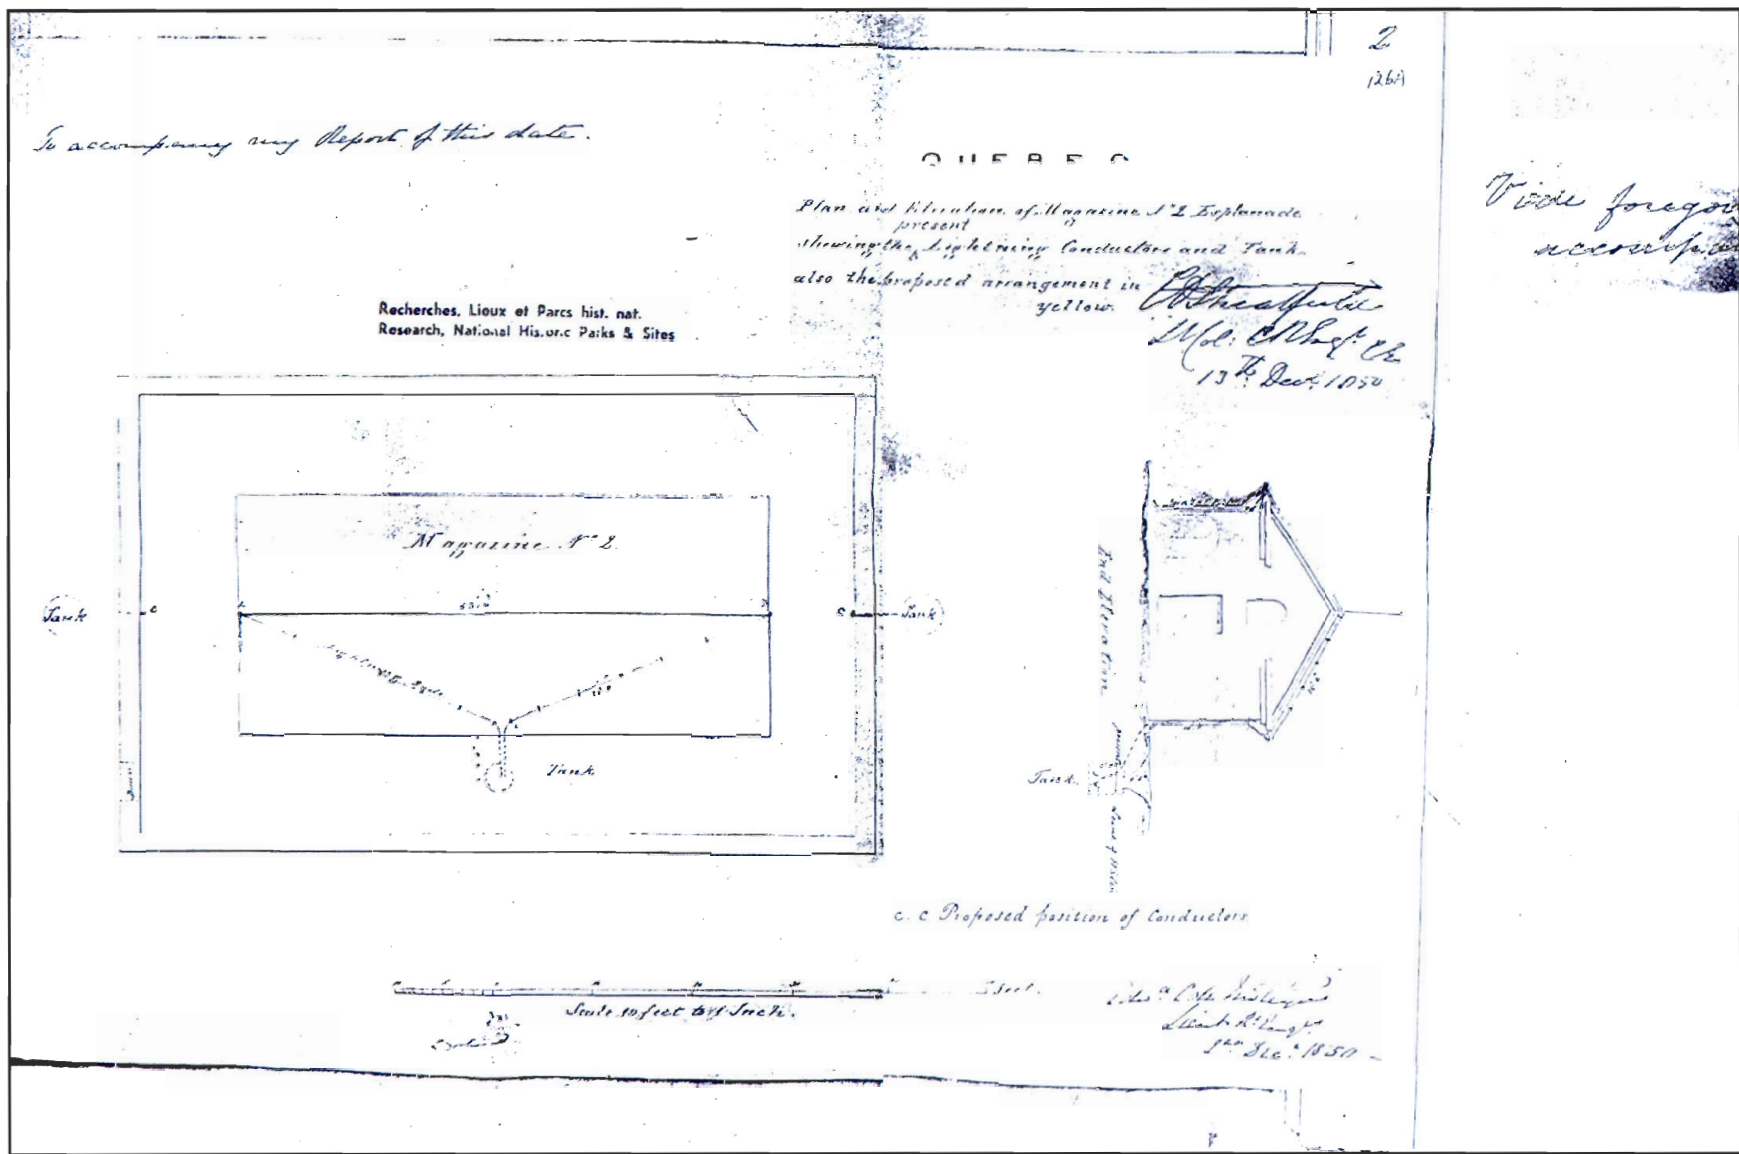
Streatfield, « Plan and Elevation of Magazine N° 2 », 1851 (PRO, WO55/885, f. 126A, 17 avril 1951)
